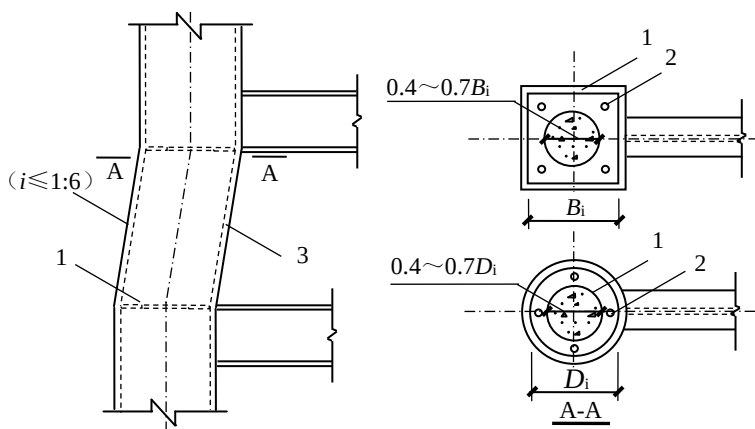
钢管再生混凝土斜柱连接构造示意图
